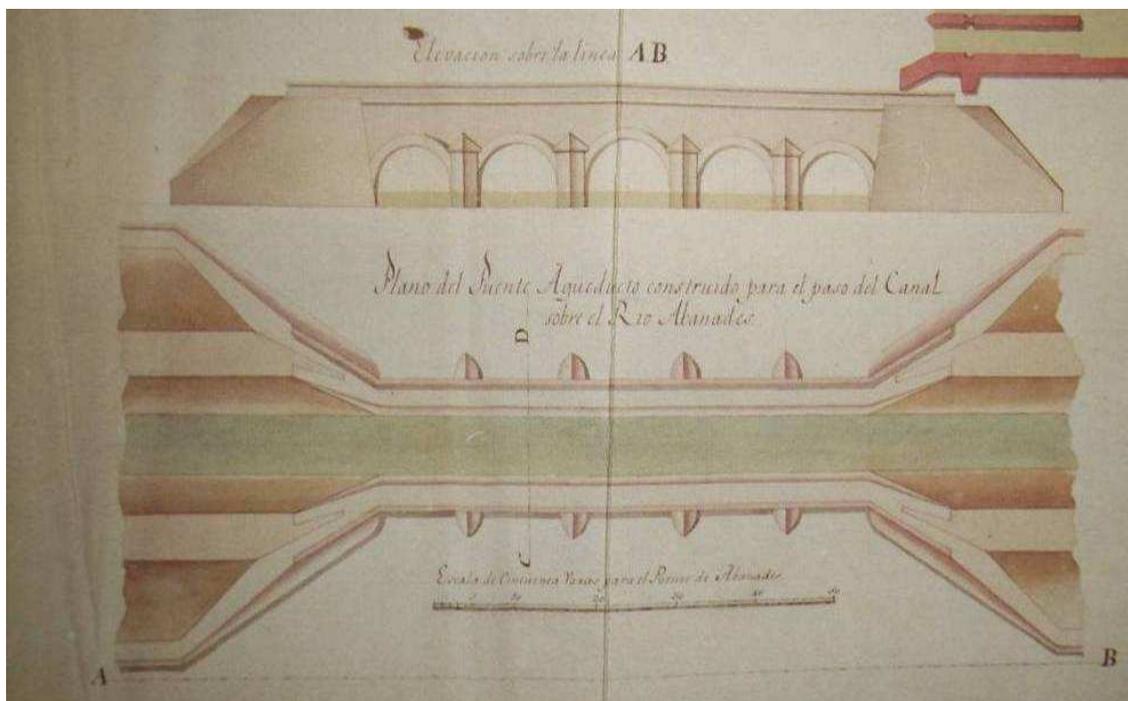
Alzado y planta del acueducto de Abánades. Juan de Homar, 1806
